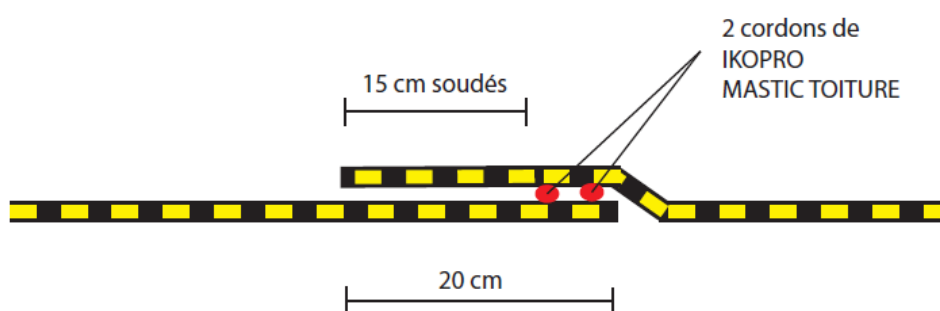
Soudure des recouvrements transversaux sur isolant fusible
